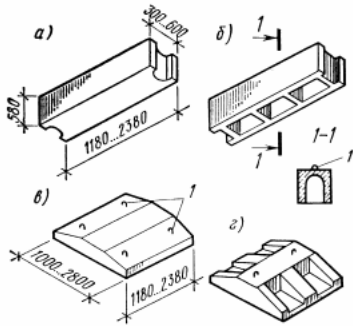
Елементи збірних бетонних і залізобетонних фундаментів:
